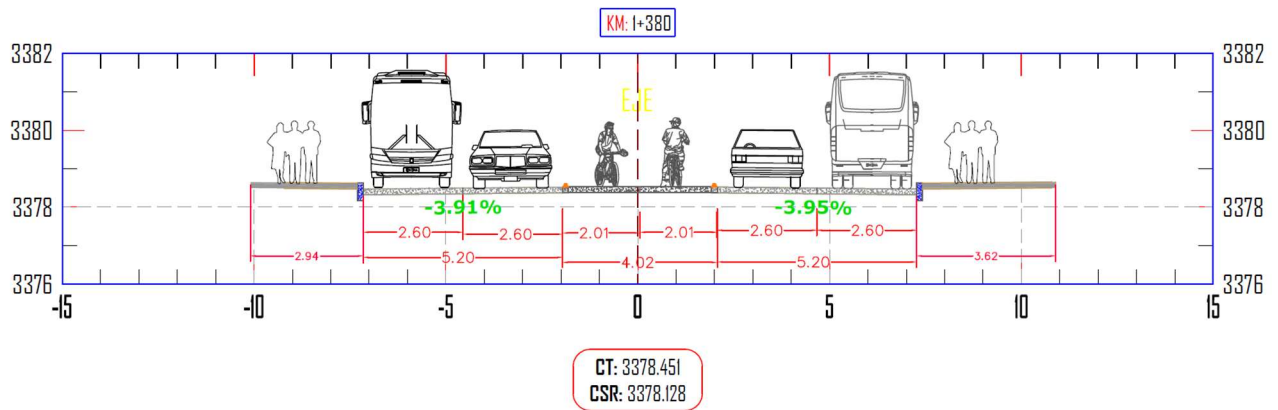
Intersección de la Av. Tullumayo con Av. Pachacutec
